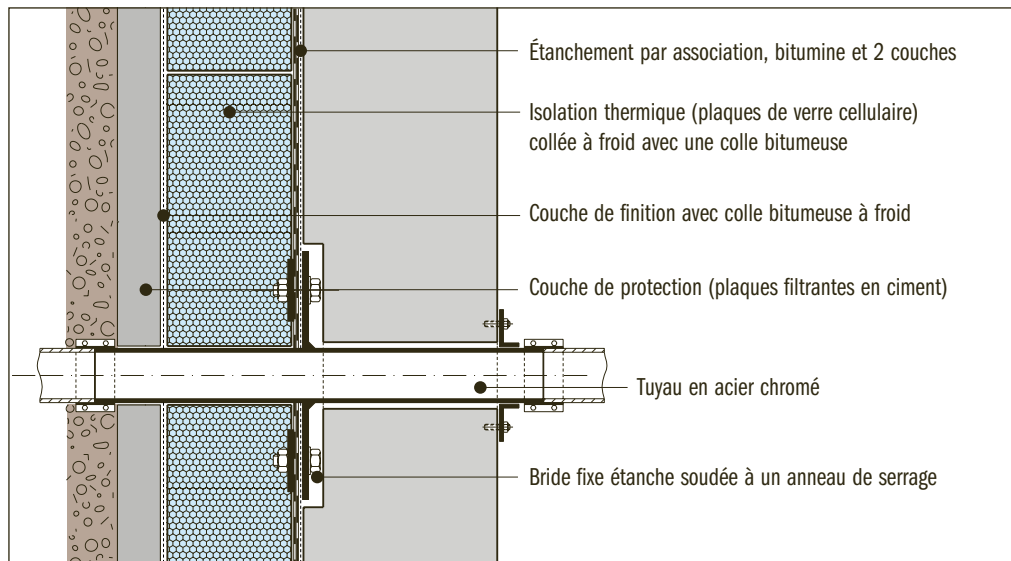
Exemple de passage mural pour tuyau étanche au radon avec une bride de collage (source: Foamglas).
